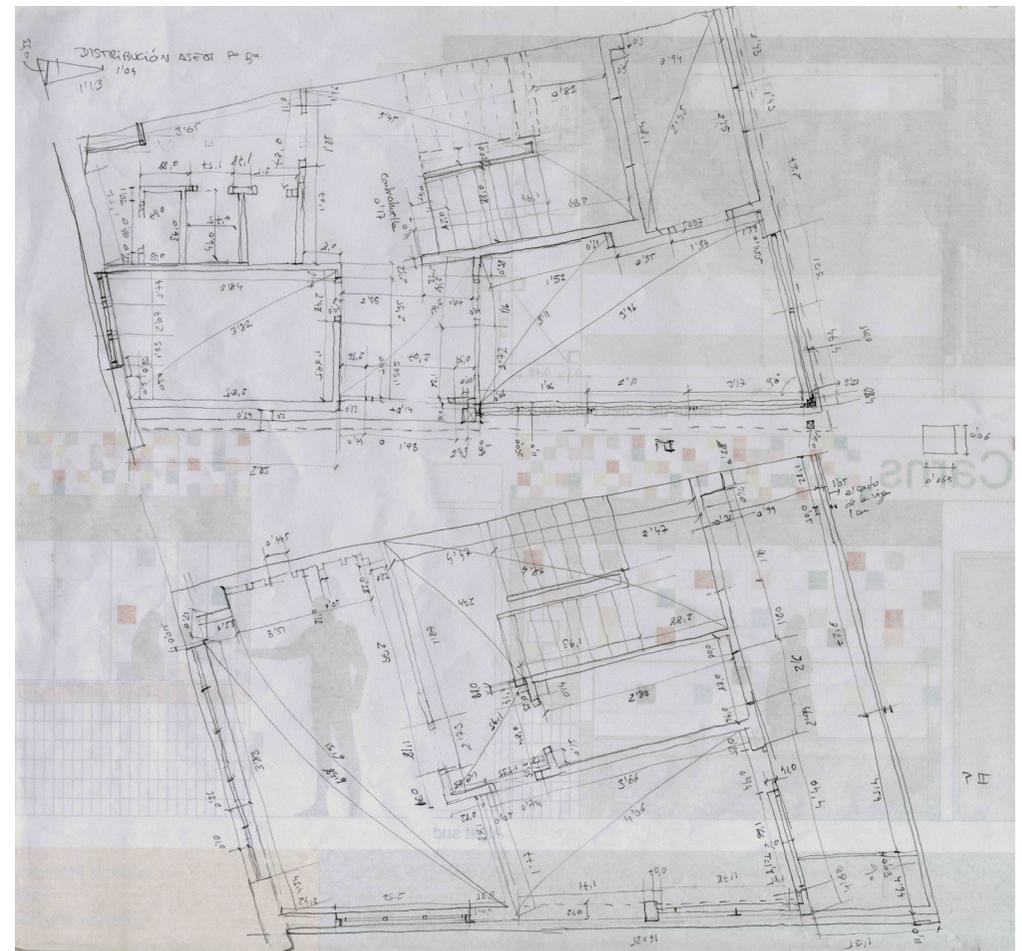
Croquis oficinas planta baja y altillo. Propia.
